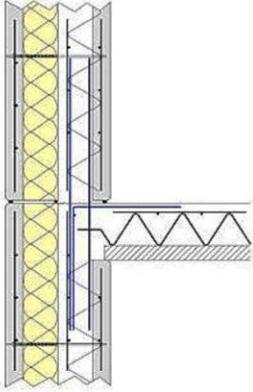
Plancher suspendu avec boîte d'attente. Celles-ci doivent respecter les dispositions du NF DTU 23.4
